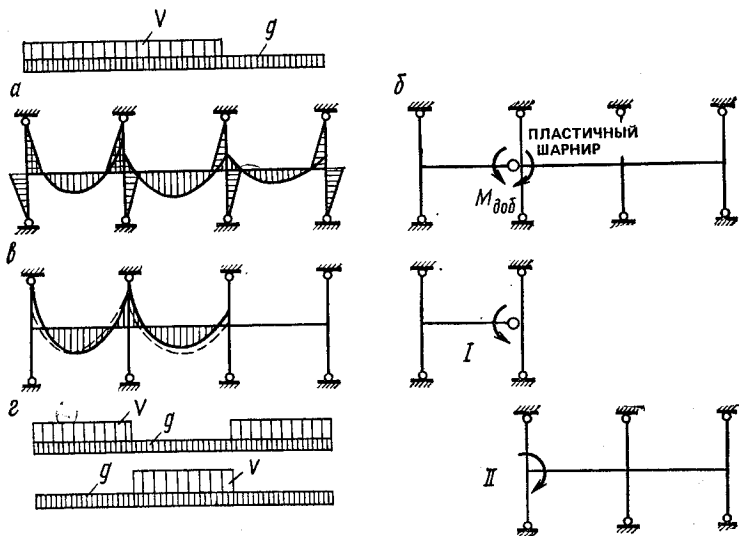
К расчету многоэтажных рам на вертикальные нагрузки по выравненным моментам
